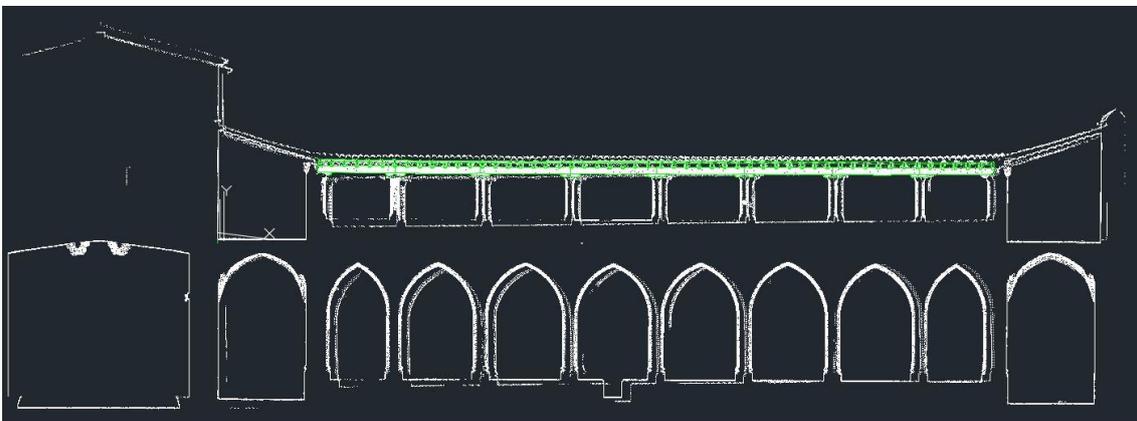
Sección dónde se obtiene forma de las vigas y viguetas de la 1ª planta del claustro.
